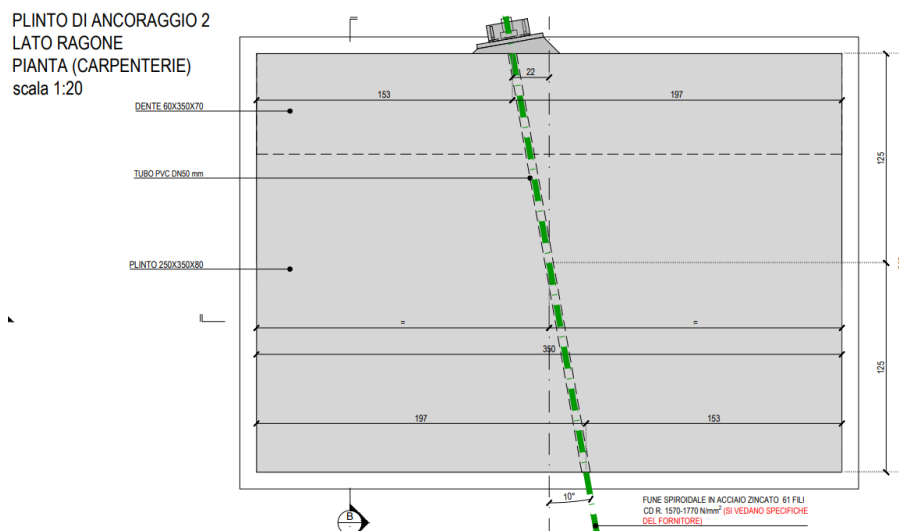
Pianta plinto su lato in direzione Ragone
